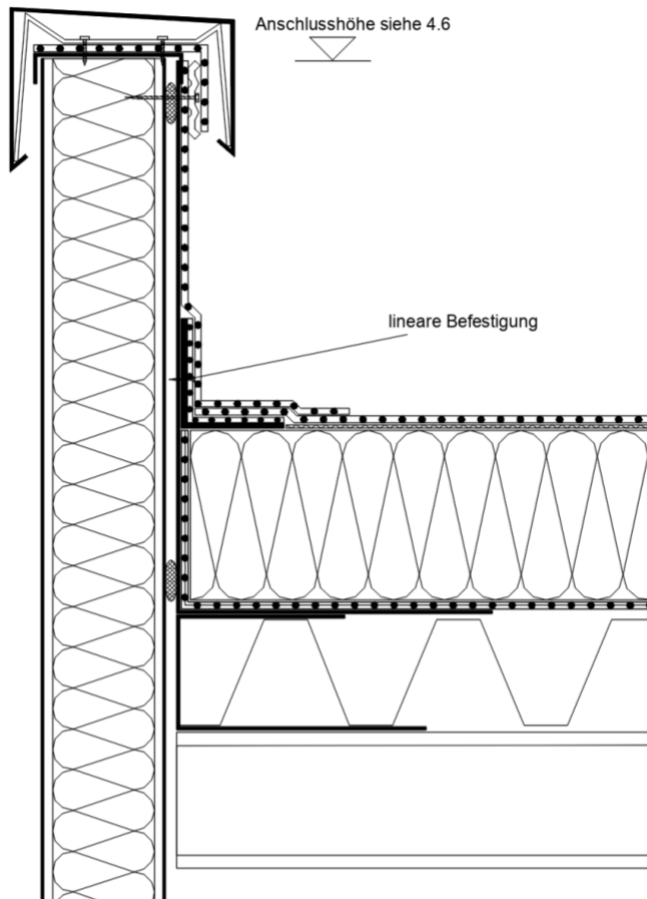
Dachrandabschluss mit mehrteiligem Profil – Ausführung mit Bitumenbahnen
